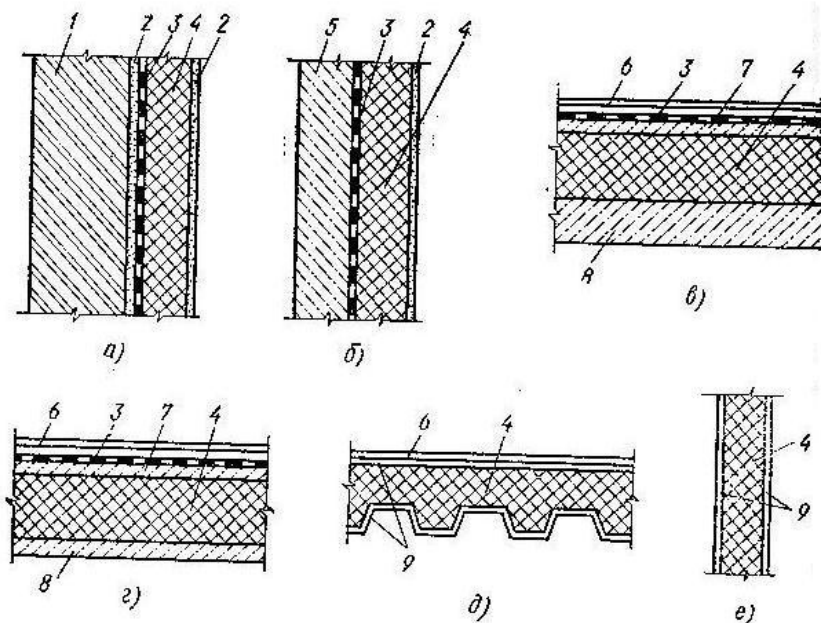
Схемы изоляции ограждающих конструкций зданий холодильников:
